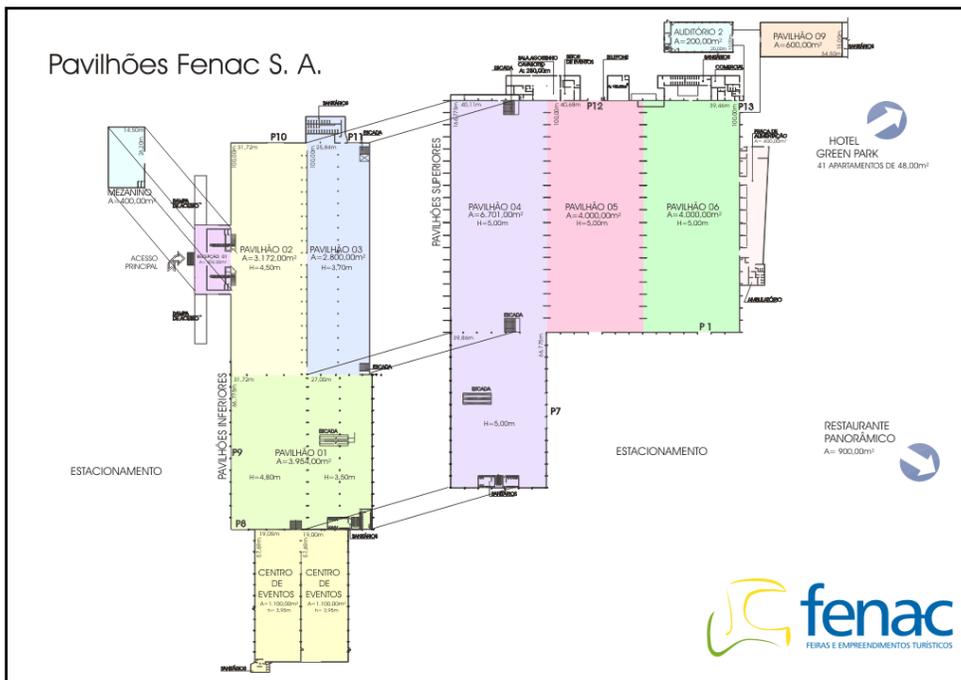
Planta Baixa dos Pavilhões Fenac S.A.
